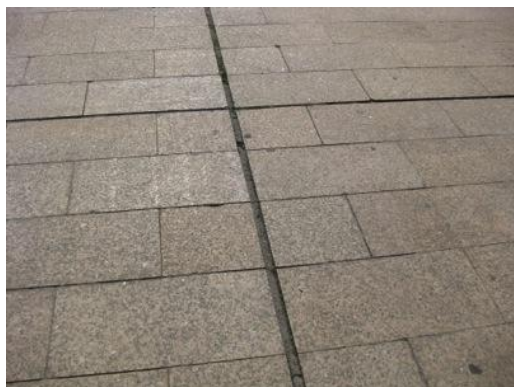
> Detalles pavimento granito plaza dels Països Catalans
